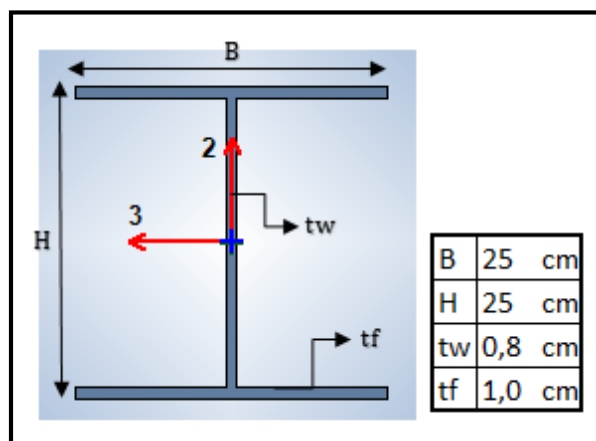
Dimensiones, Columna 2 con pórticos arriostrados diseñados con la NEC.
